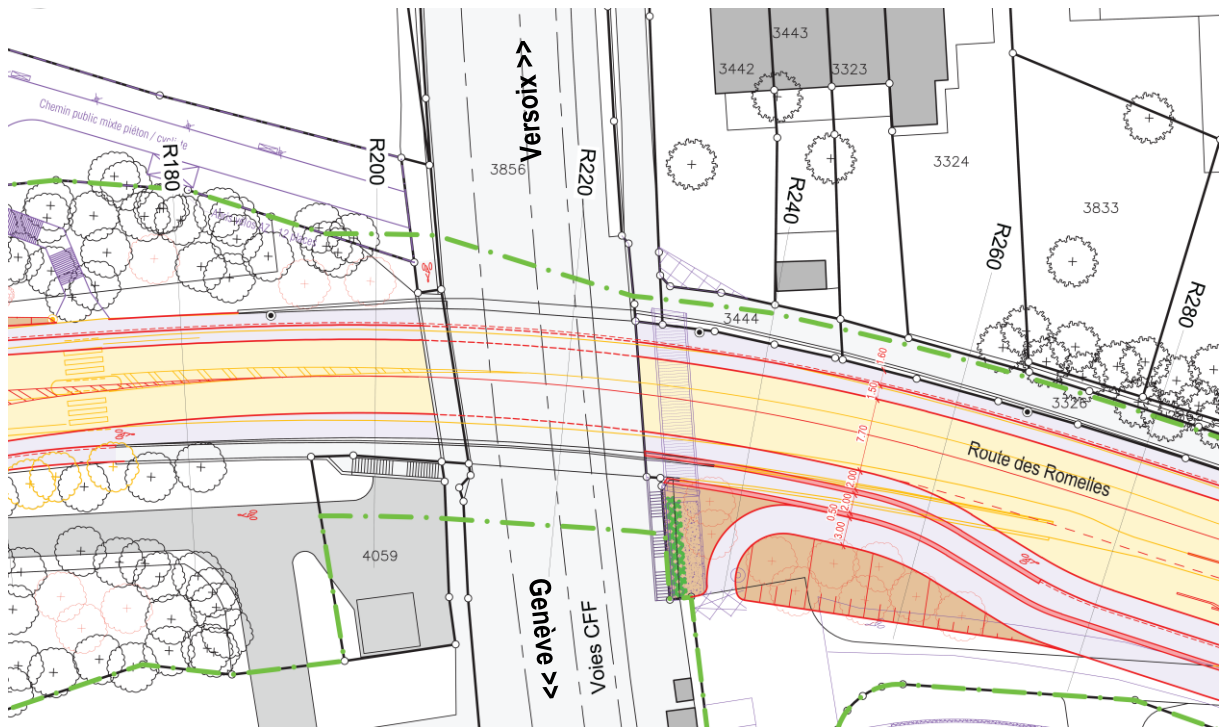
Extrait du plan de situation (source : Groupement VERO)
